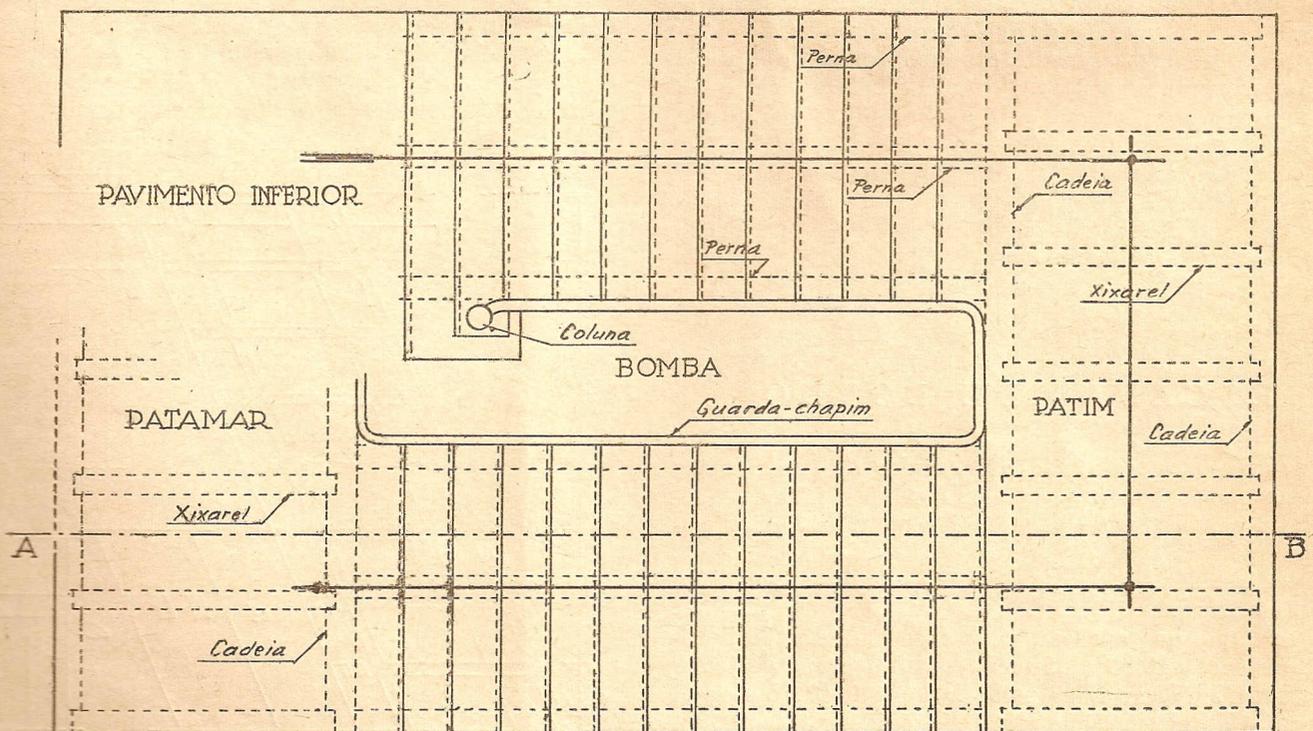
PLANTA DE ESCADA DE DOIS LANÇOS PARALELOS
